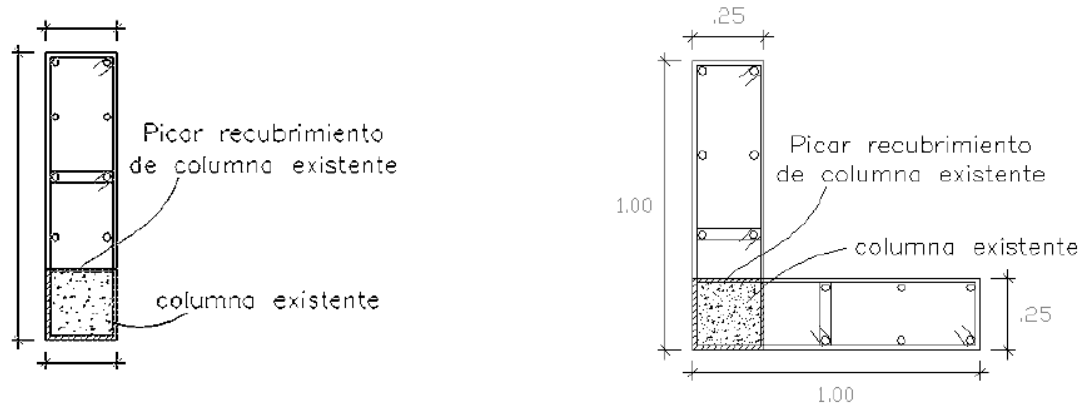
Detalle de reforzamiento para columna existente y esquinera
